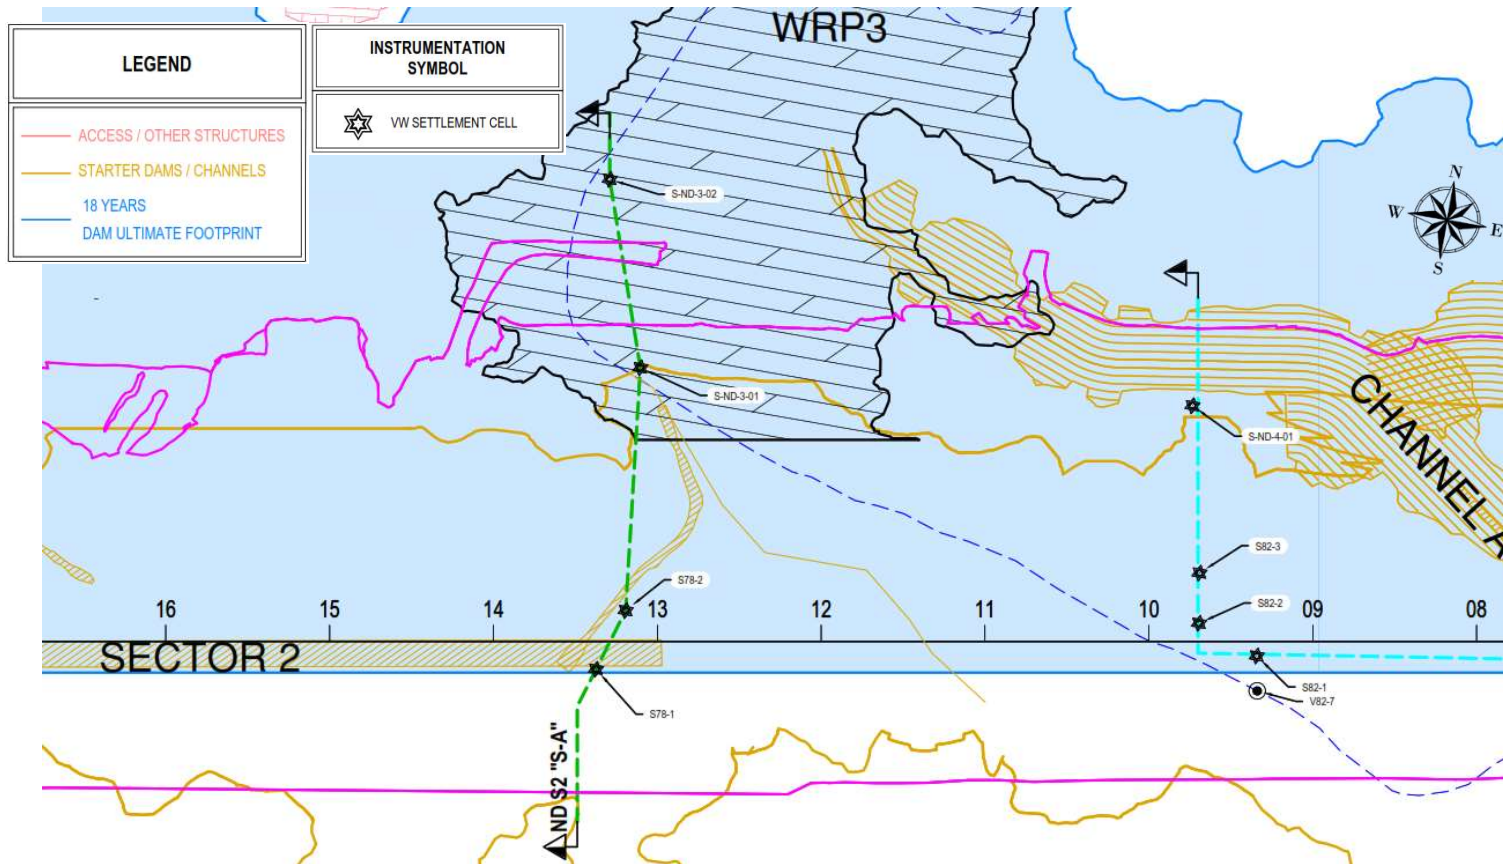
1: PN Sector 2 Vista en planta de grupos de instrumentos de celdas de liquidación
